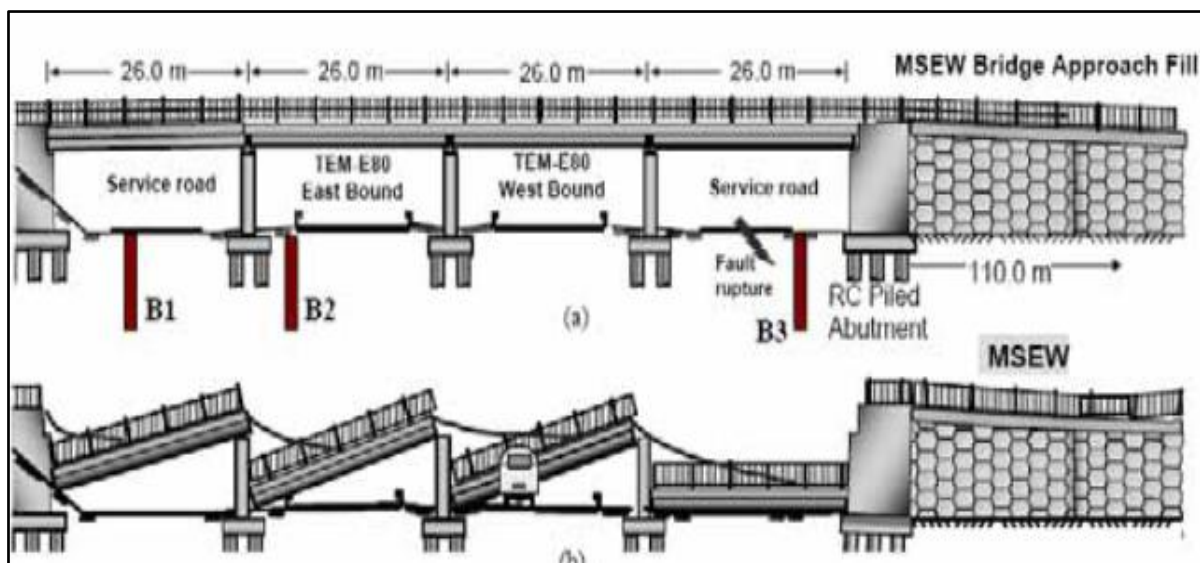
L'effondrement du pont de l'autoroute (TEM) (Séisme de Kocalei 1999)
